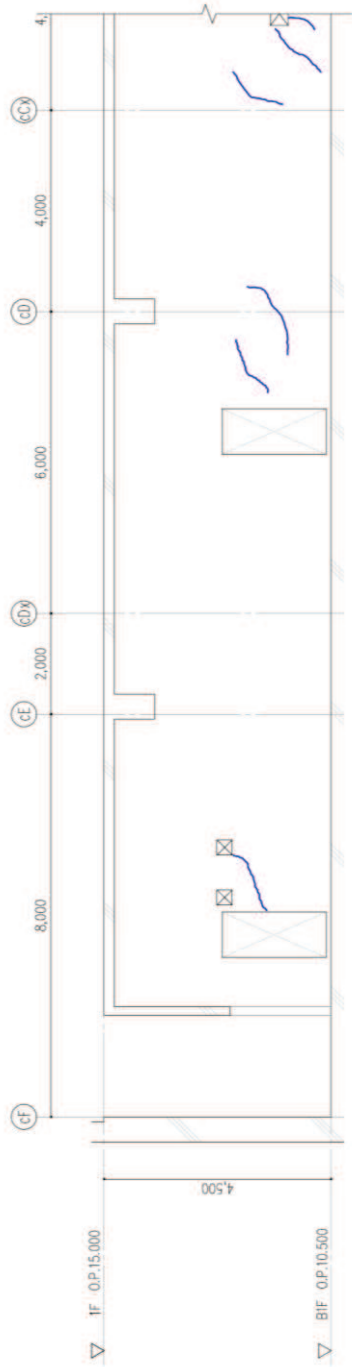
第 1 号機制御建屋のひび割れ分布 耐震壁 (13) 地下 2 階 CF 通り
